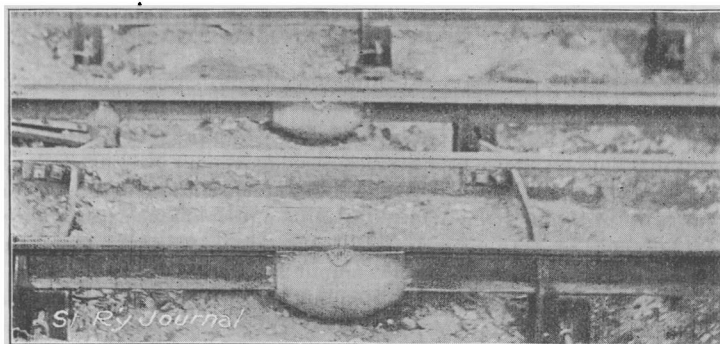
Vue d'un joint soudé à la fonte.
